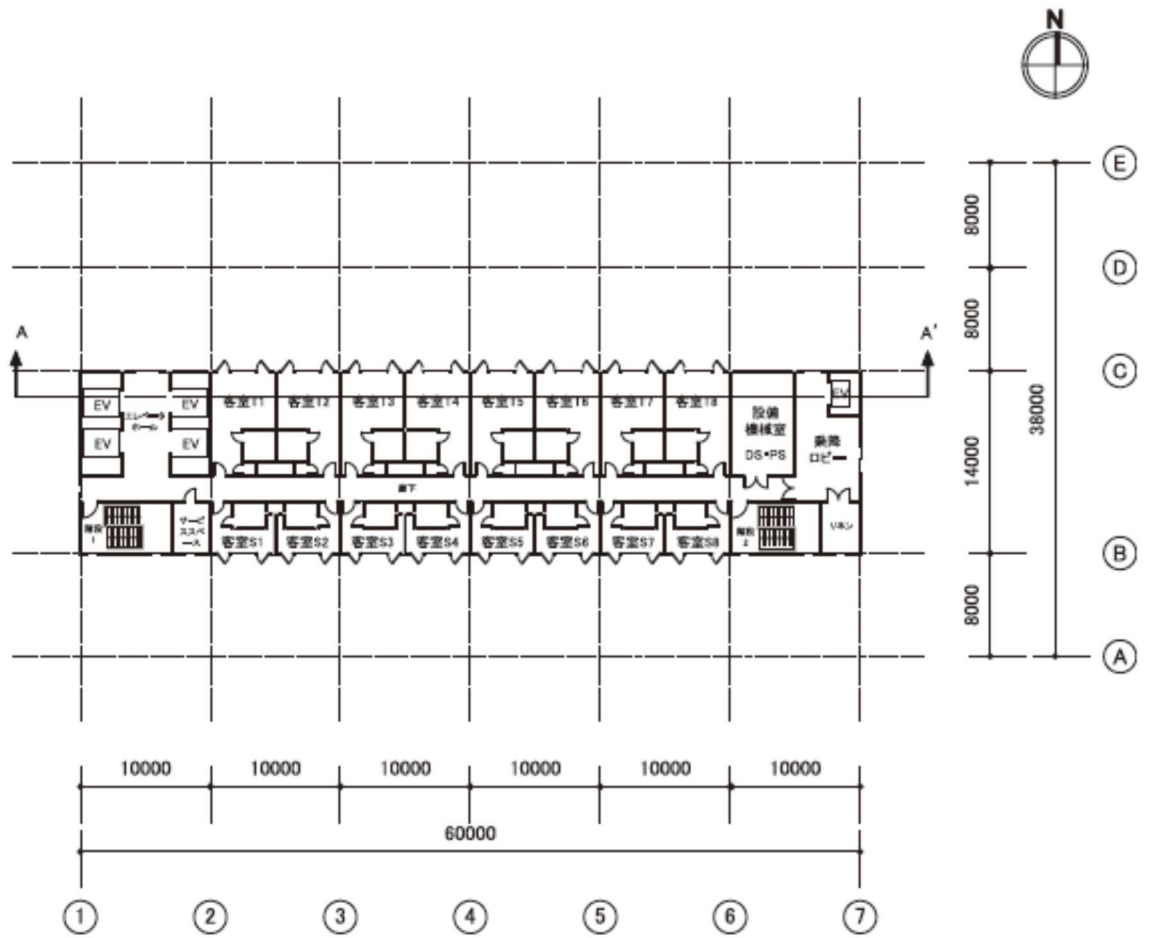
1 モデル建物（シティーホテル等） 4～12階平面図
